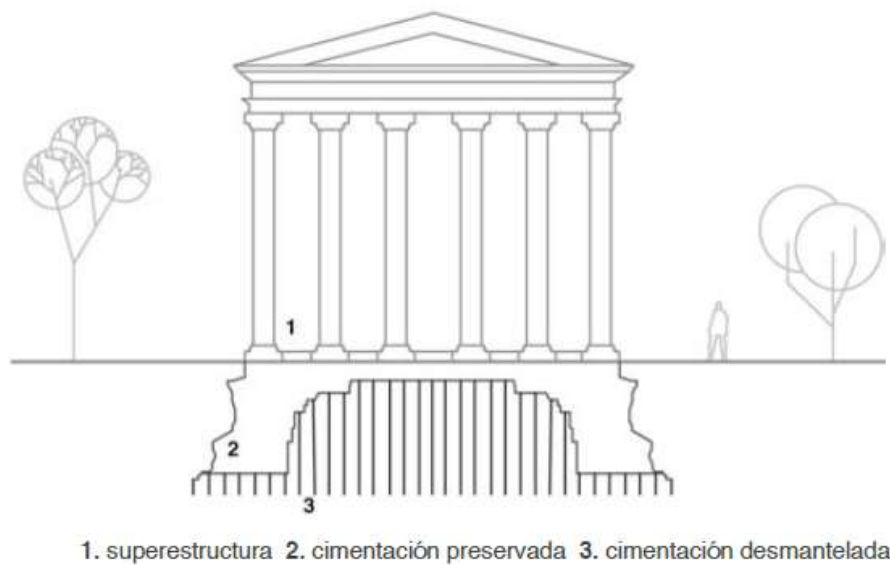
27- Desmantelamiento de la sección existente (Oliveira y Márcia., 2008).
